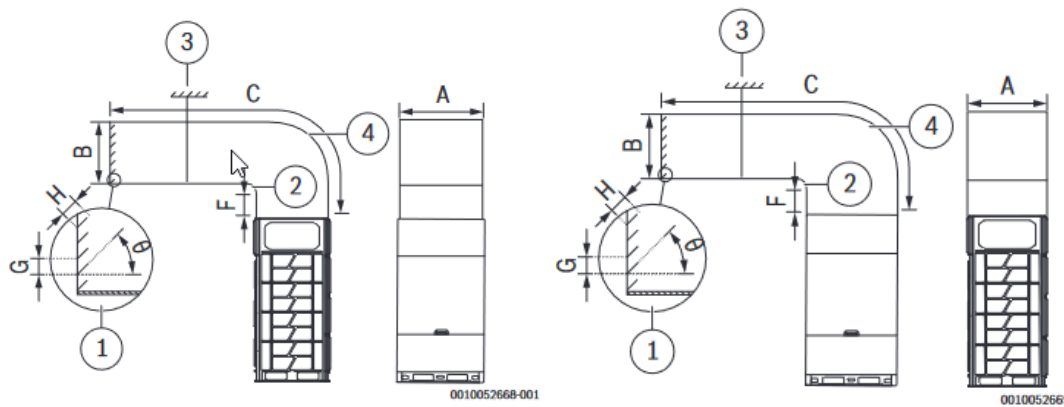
Condutas transversal (opção A) e Condutas longitudinais (opção B)
